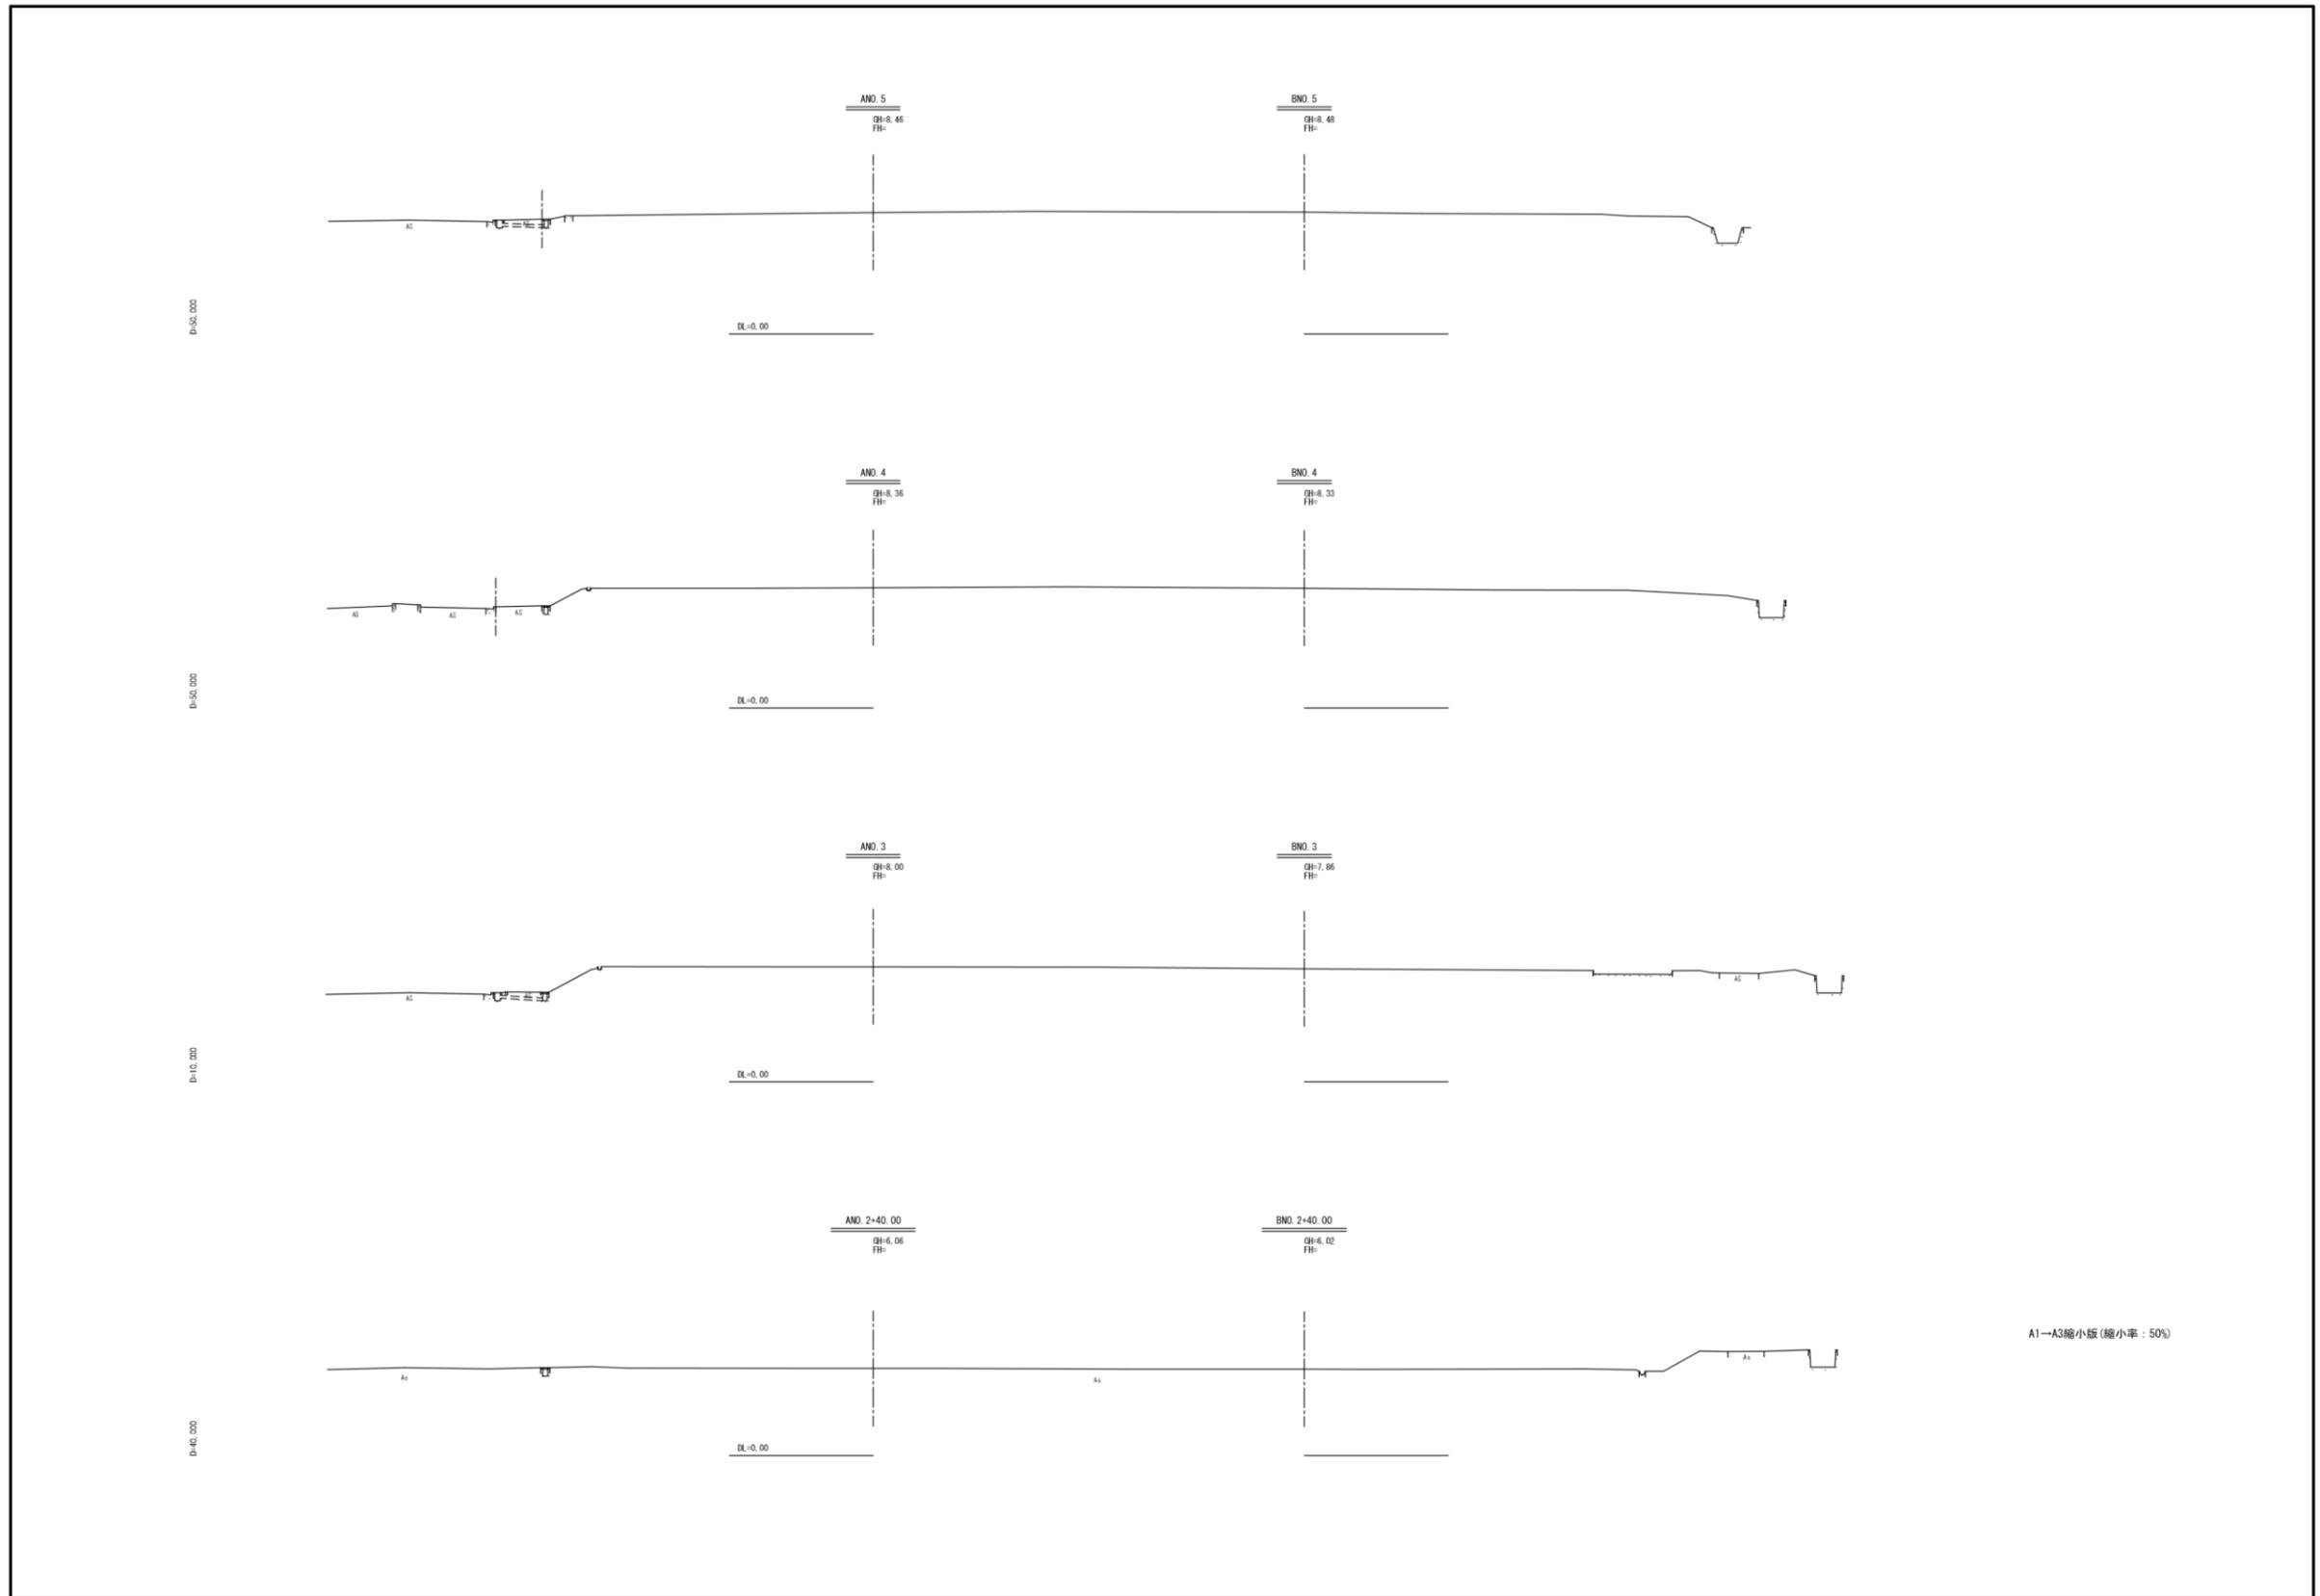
NO.2+40.00~5 横断面图 (縮尺 1:200)
